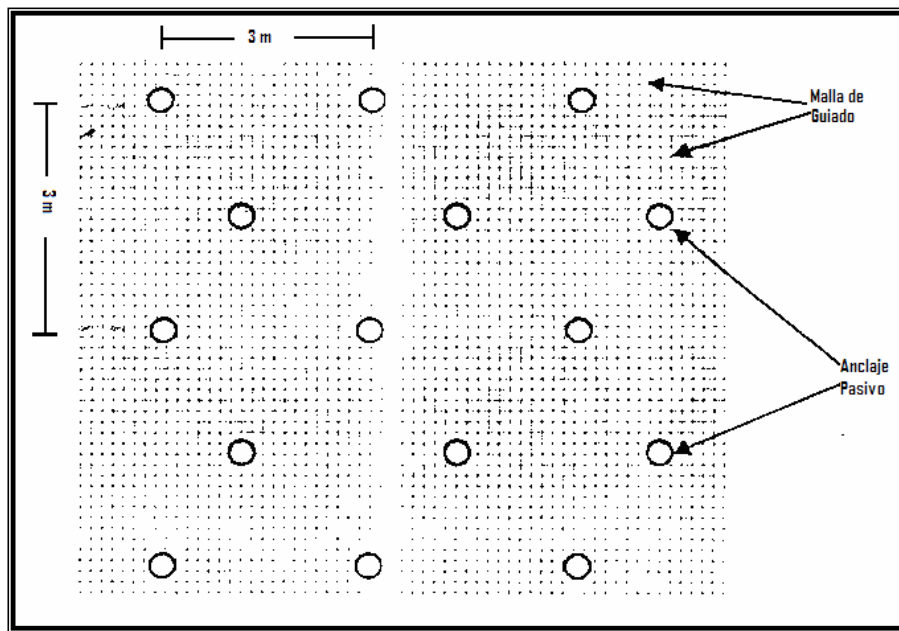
Esquema de planta de la Malla de Guiado con anclajes pasivos.
